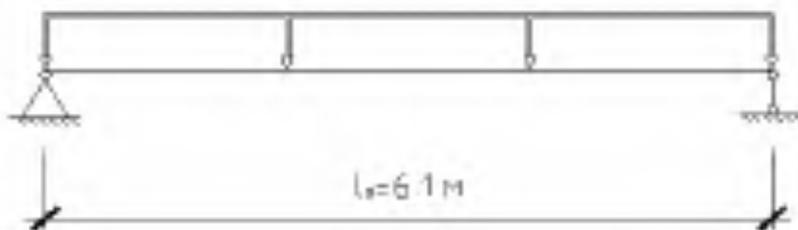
Схема завантаження багатопустотної панелі перекриття
